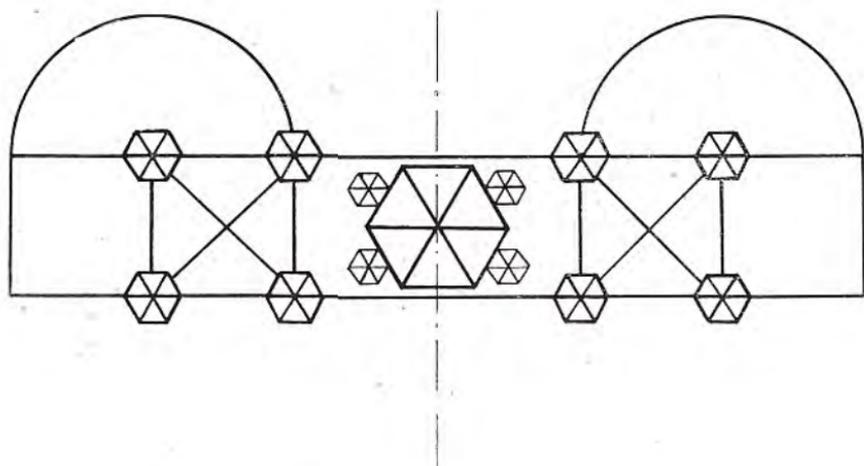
Planta de la Puerta Nueva de Guadalajara.
